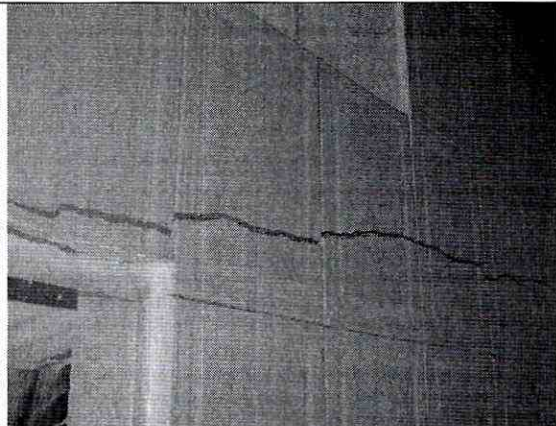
Grieta en el segundo nivel de la vivienda, hacia el costado Norte de la misma.
